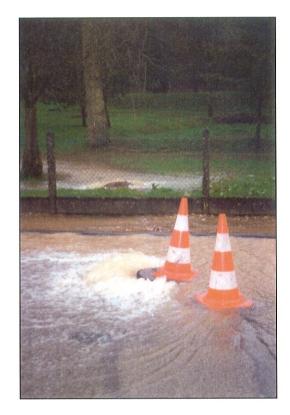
Inondation de la place de la Fontaine et du carrefour avec la RD 61.
